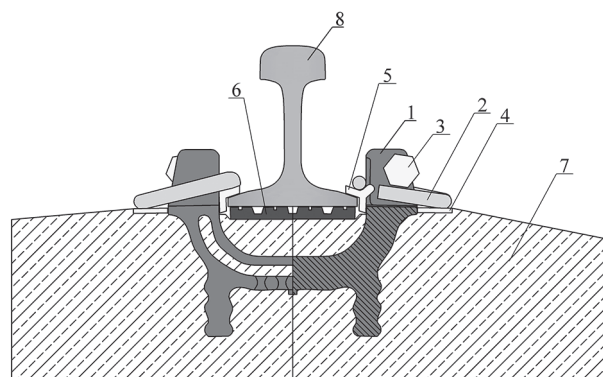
Рельсовое промежуточное крепление АРС: 1 — анкер; 2 — клемма; 3 — монорегулятор; 4 — подклеммник; 5 — изолирующий уголок; 6 — подрельсовая прокладка; 7 — шпала; 8 — рельс
